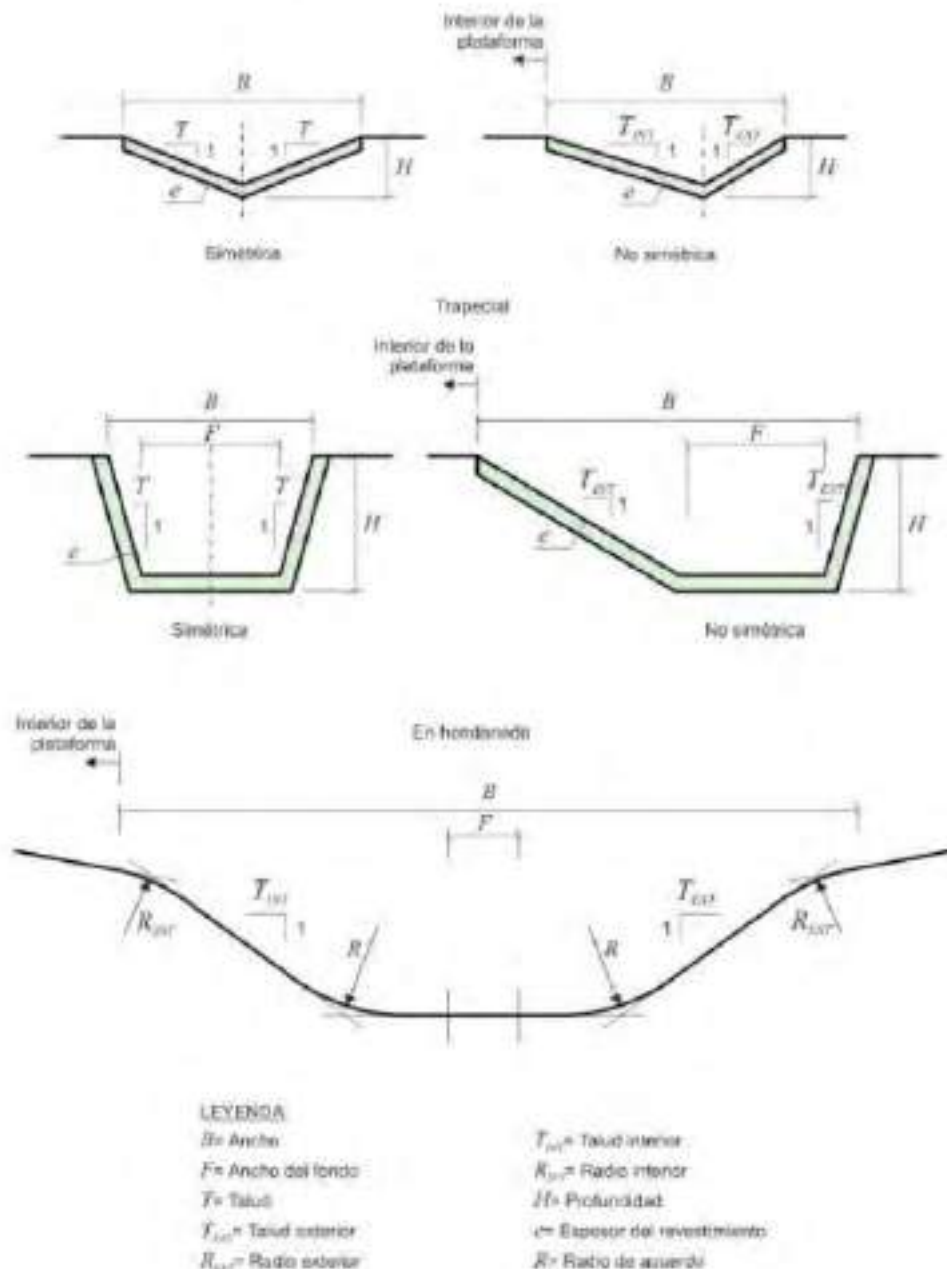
Tipos de cunetas (Fuente: Norma 5.2-IC)
